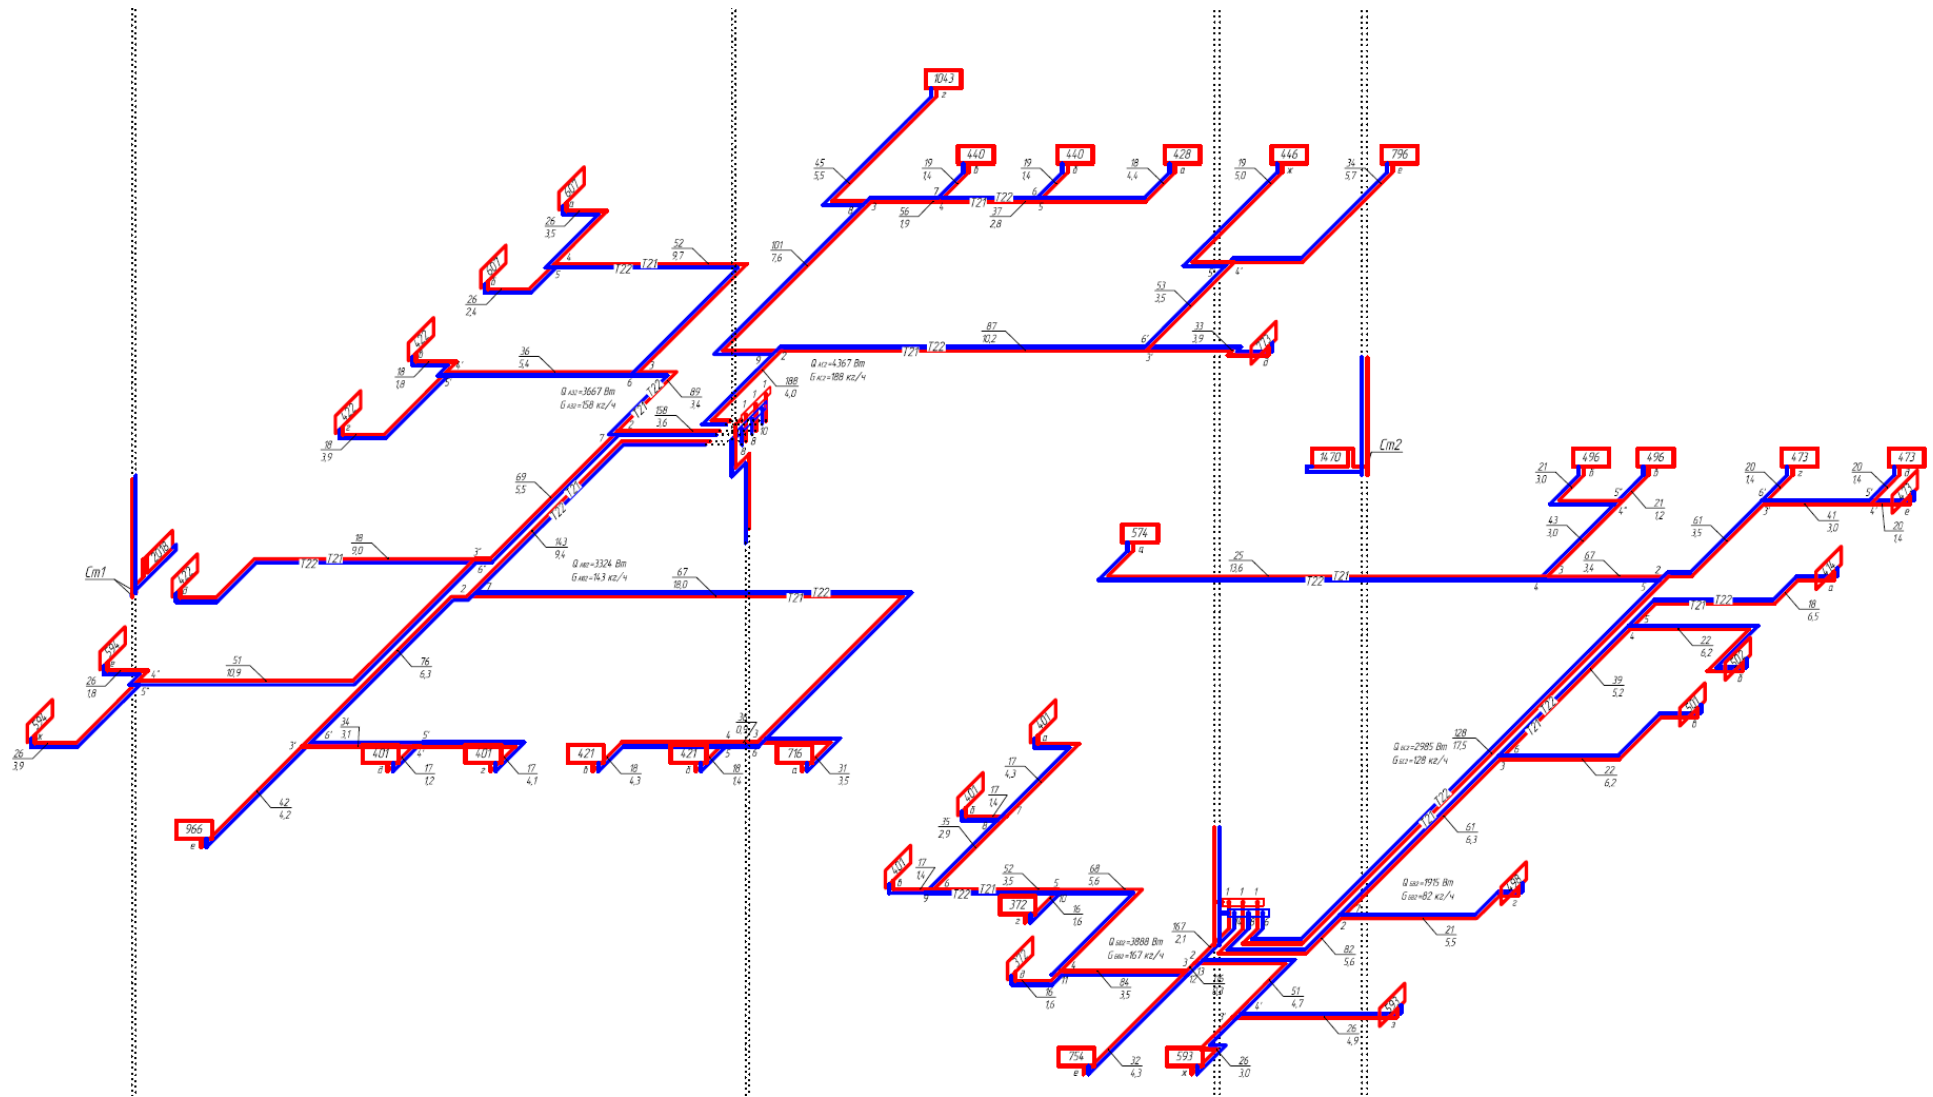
Расчетная схема системы отопления 2 этаж
